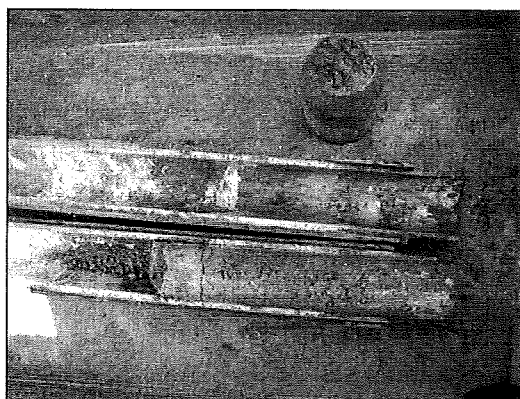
Sondeig S-3. SPT a 4,5 metres.
